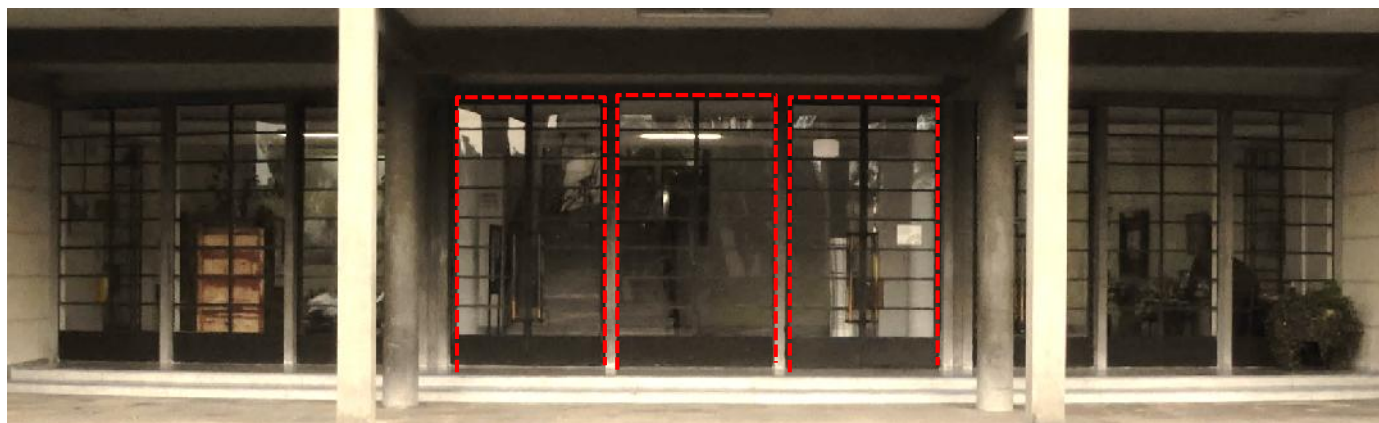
Vistas del estado actual. Fotografía CNM.
